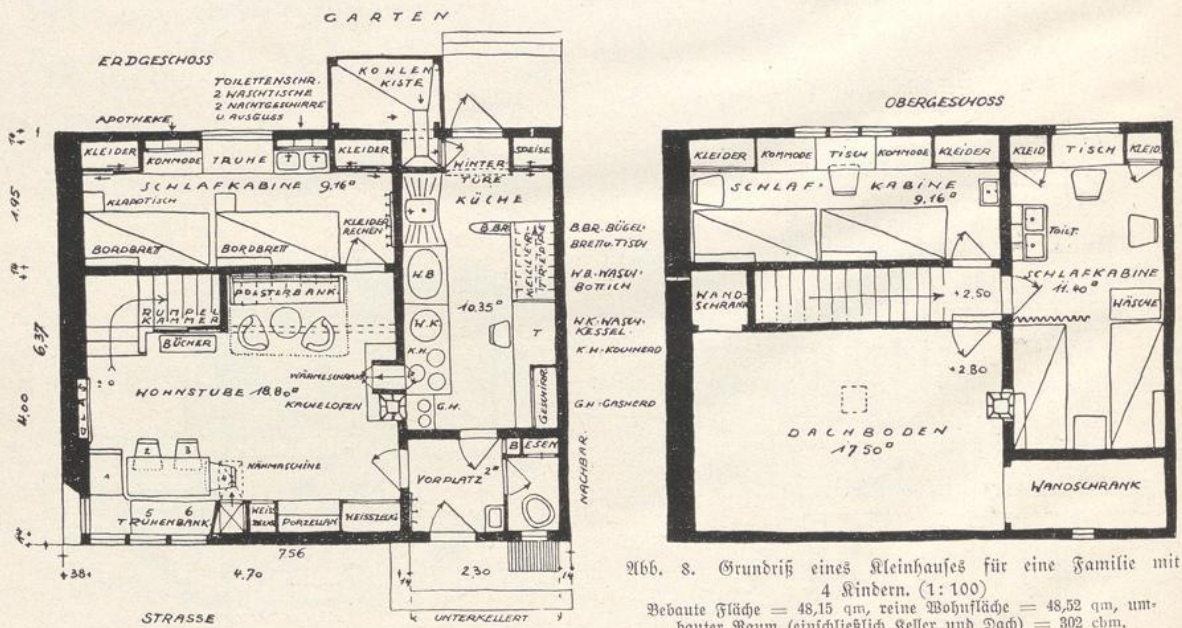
Grundriß eines Kleinhauses für eine Familie mit 4 Kindern. (1:100)
